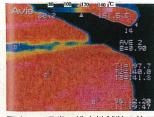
通常の排水性舗装の施工 直後の舗装表面の温度分 布(夏期)
